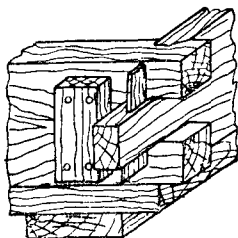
Прочные и плотные соединения углов круглыми фрезерованными шипами:
